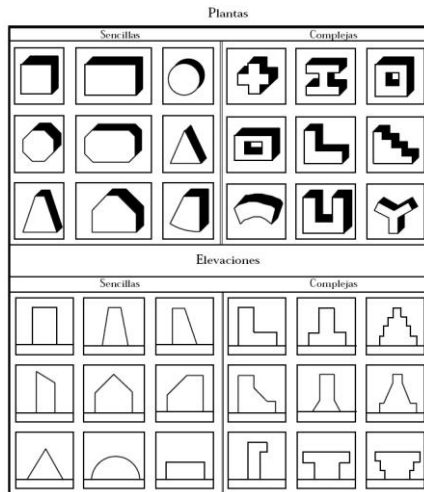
Formas Sencillas y Complejas en Planta y Elevación
